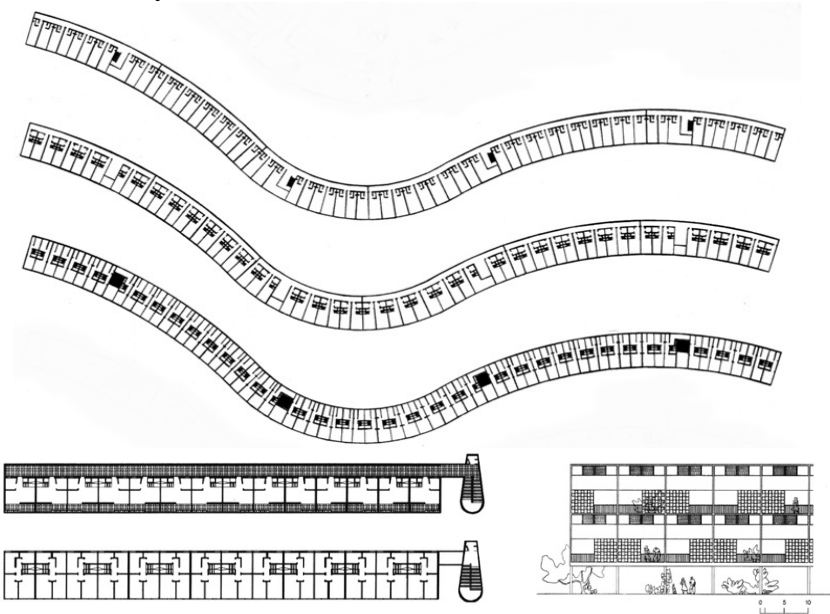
a e b) Plantas baixas do pavimento tipo com destaque para o edifício principal com planta serpenteada. c) Fachada. Fonte: Koury; Bonduki; Manoel (2003).
